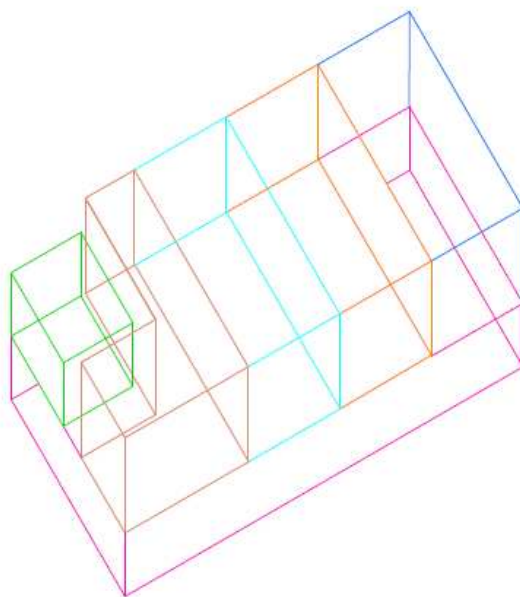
Planta do Galpão com zona 03 – subsolo. (BÜTTNER, S.)
